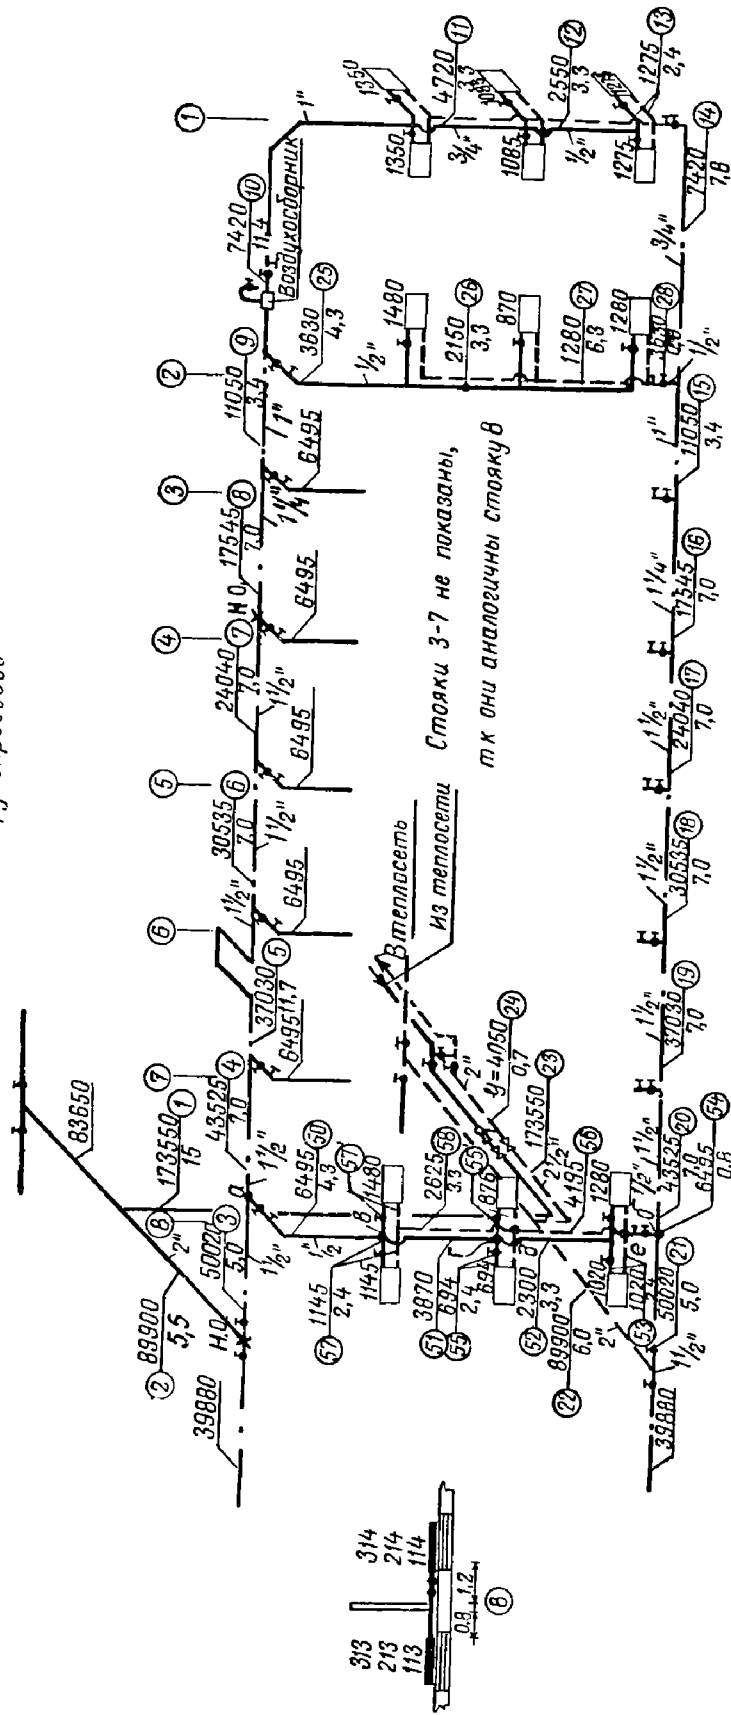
Двухтрубная система отопления с верхней разводкой трехэтажного жилого здания
